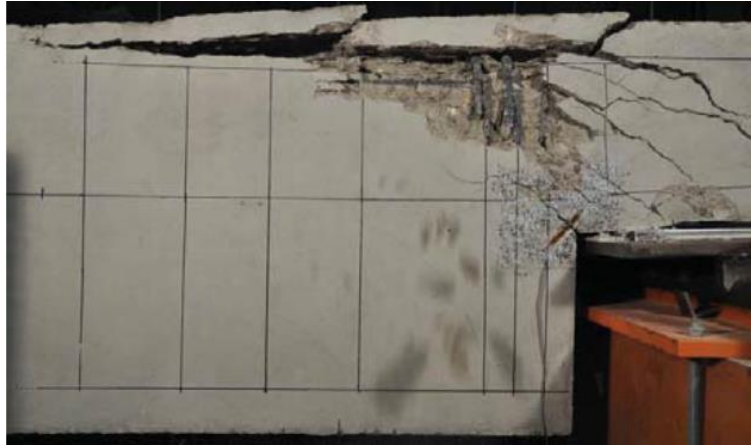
Vista general del espécimen DEB-1.6 (T1) tras la rotura, extraído de Mata [6].
